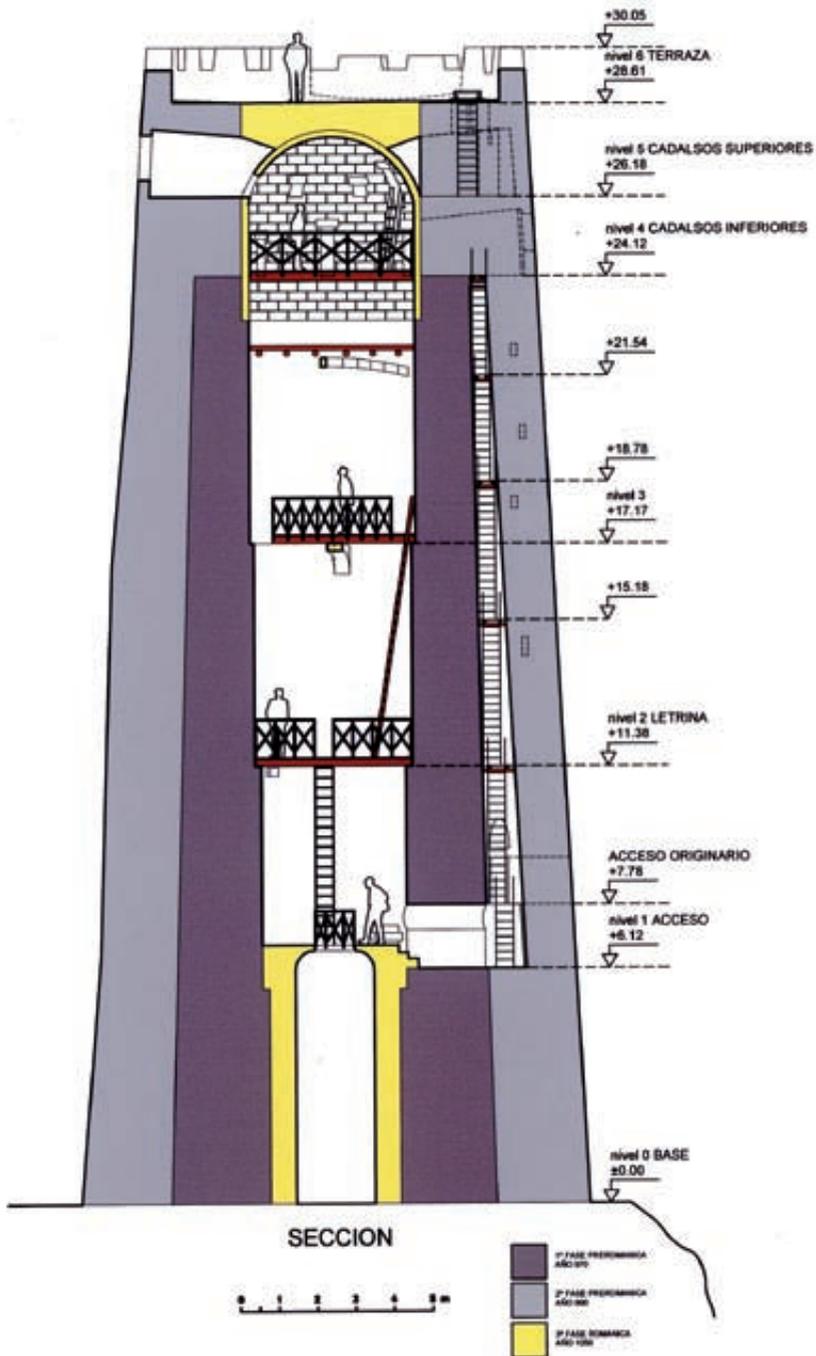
Plano de sección en el que se indican las tres fases constructivas y los elementos repuestos en los trabajos de restauración.
